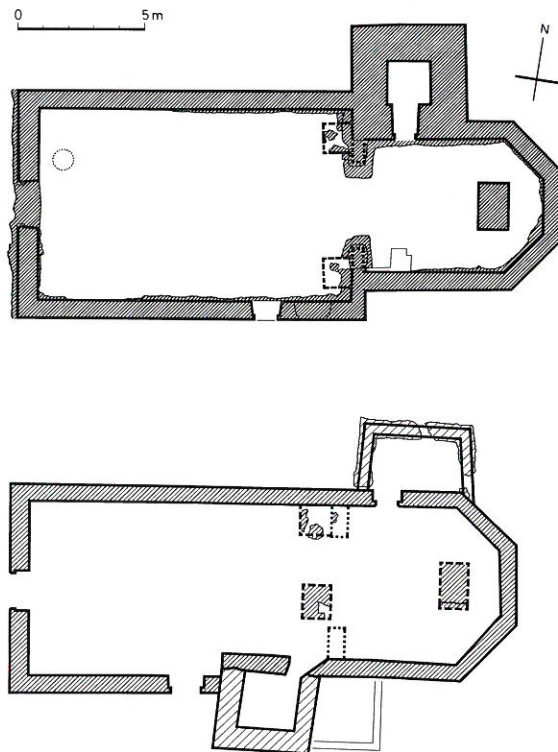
Grundriss der Kirchen von Wengi BE (oben) und Walkringen (unten). M. 1: 300.
